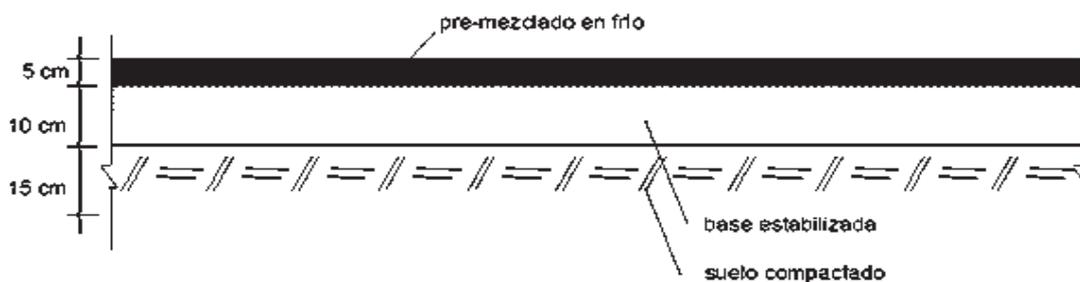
Pavimento en concreto asfáltico – mezcla en frío.
